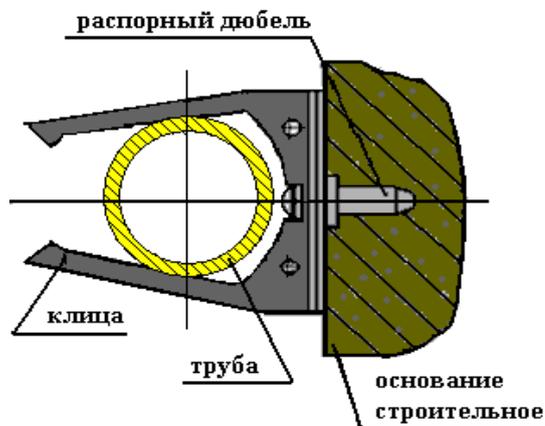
Крепление пластмассовых труб с применением электромонтажной конструкции к строительному основанию с помощью распорного дюбеля
